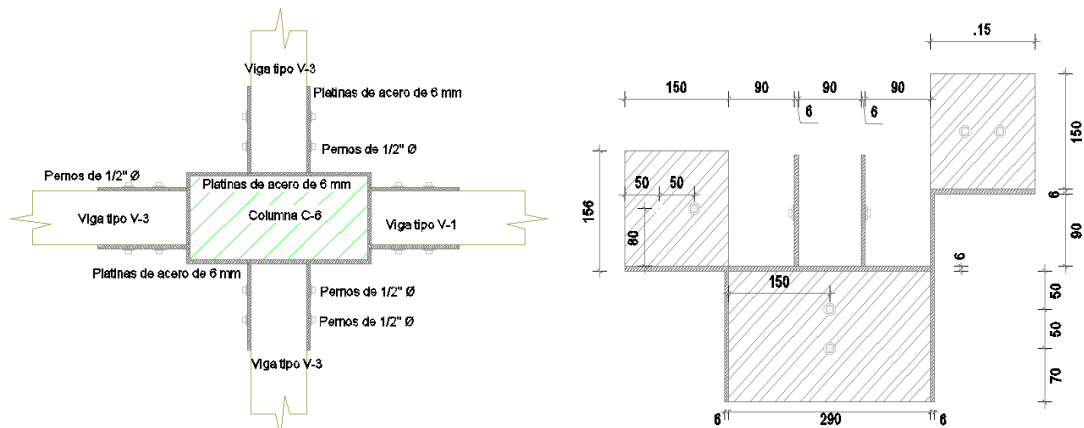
Esquema unión Viga – Columna (Nudo entre eje C y 2, primer entrepiso, medidas en mm)
